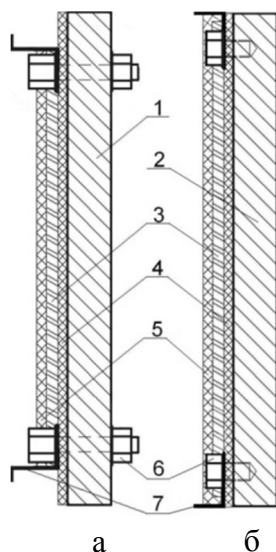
Конструкции греющего щита термоактивной опалубки (а) и греющей плиты пресса (б) с электрическим нагревателем из КРМ: щит (1); плита (2); КРМ (3); диэлектрическое покрытие (4); теплоизоляционное покрытие (5); крепежное соединение (6); электроды (7)
